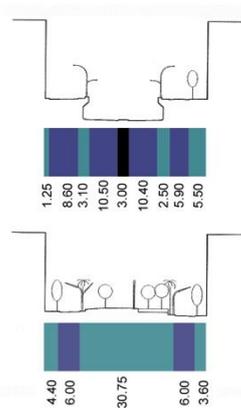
A e B. Intervenção sobre Avenida em Barcelona.
